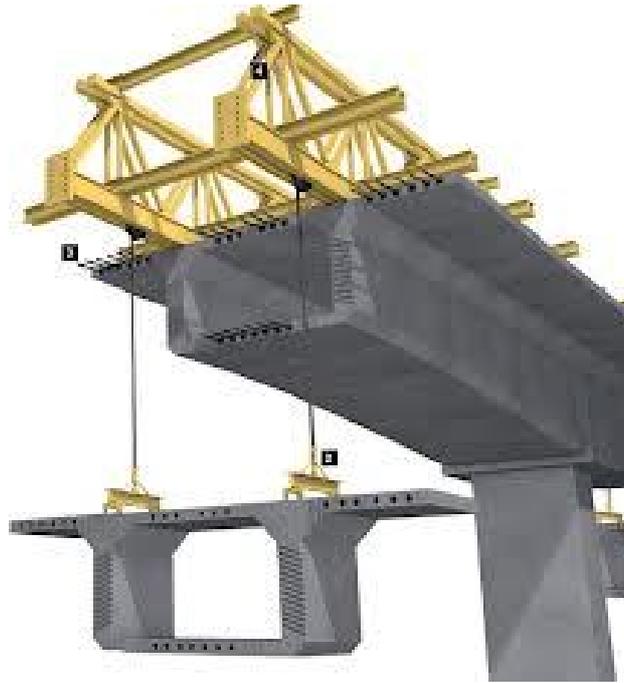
Execução de balanços sucessivos com aduelas pré-moldadas (Fonte: Revista Infraestrutura, Ed 21, 2012).
